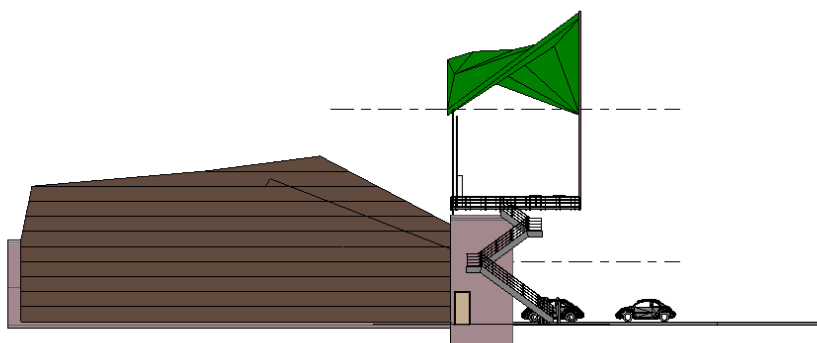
Архитектурно-планировочное решение (фасад – северный)
